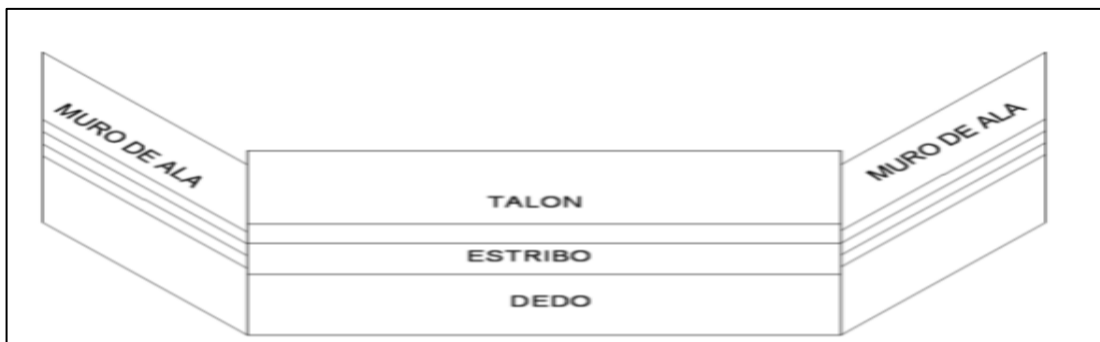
Vista superior de ubicación del estribo con los muros ala.
